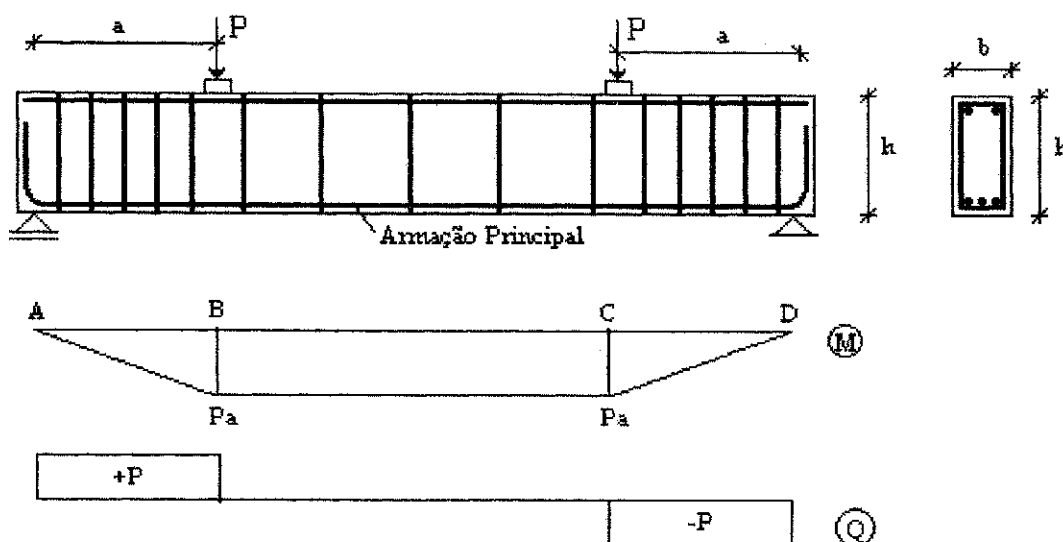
Viga Bi-Apoiada Utilizada nos Ensaio de Stuttgart
